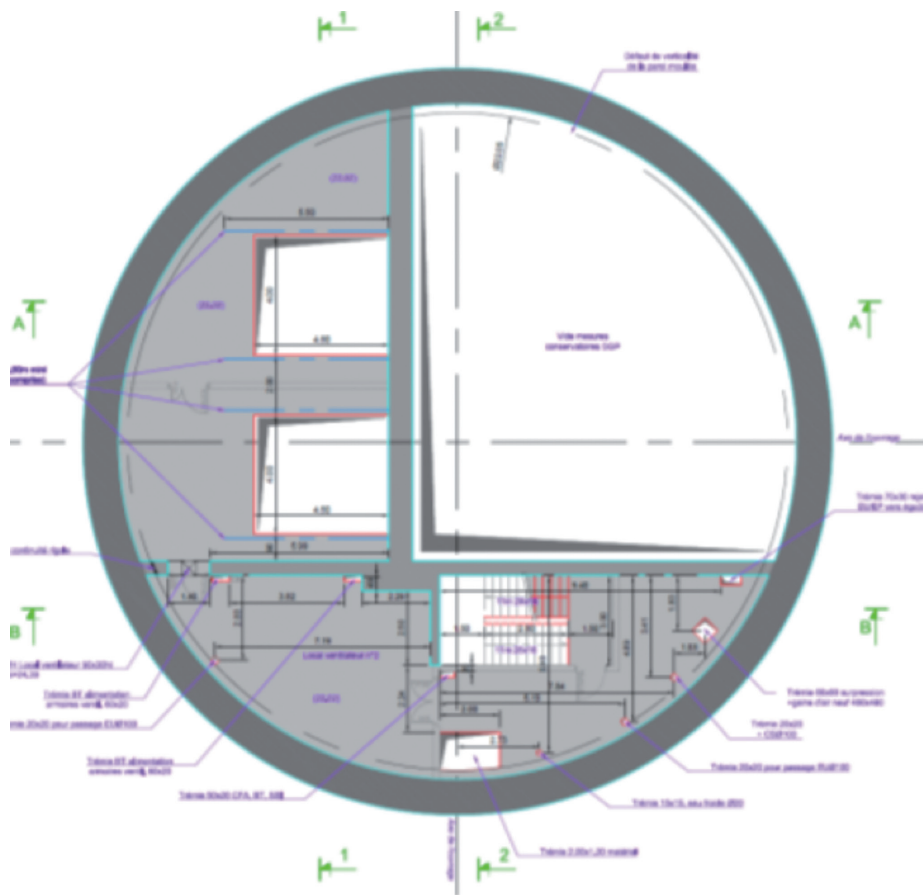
Puits Pleyel – Vue en plan de la trémie de démontage du tunnelier, niveau intermédiaire
